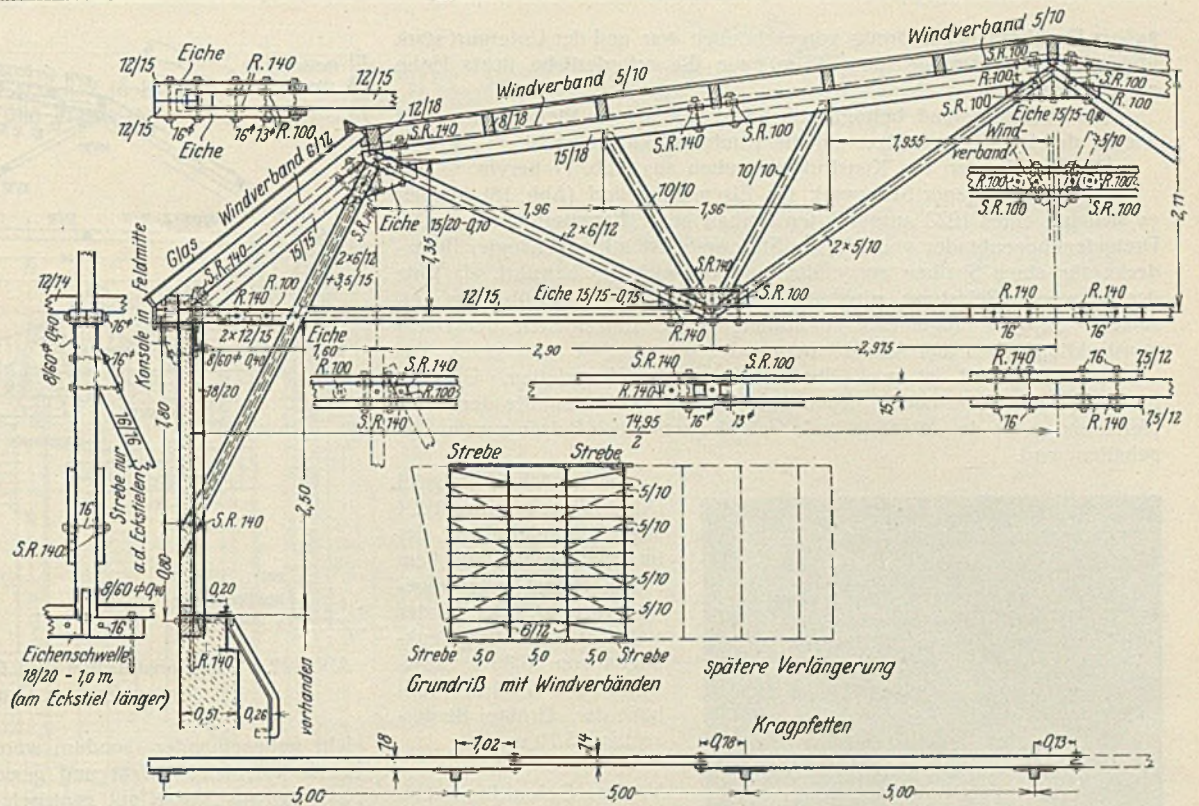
Dachkonstruktion für das Siegener Stanzwerk für Eisenbahnbedarf.
